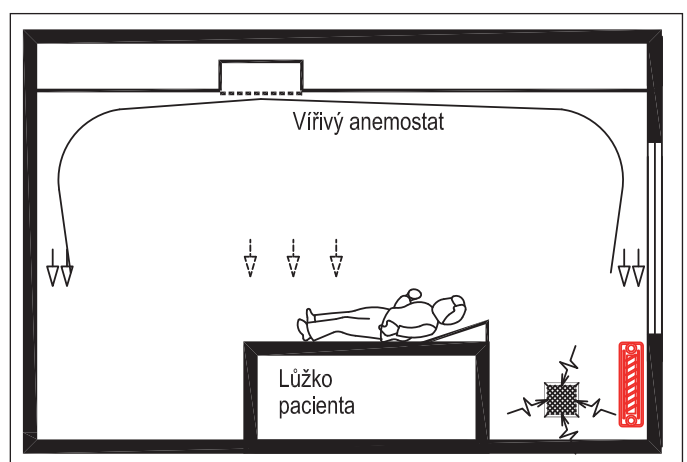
Příklad podkladu výrobce k vířivým anemostatům
